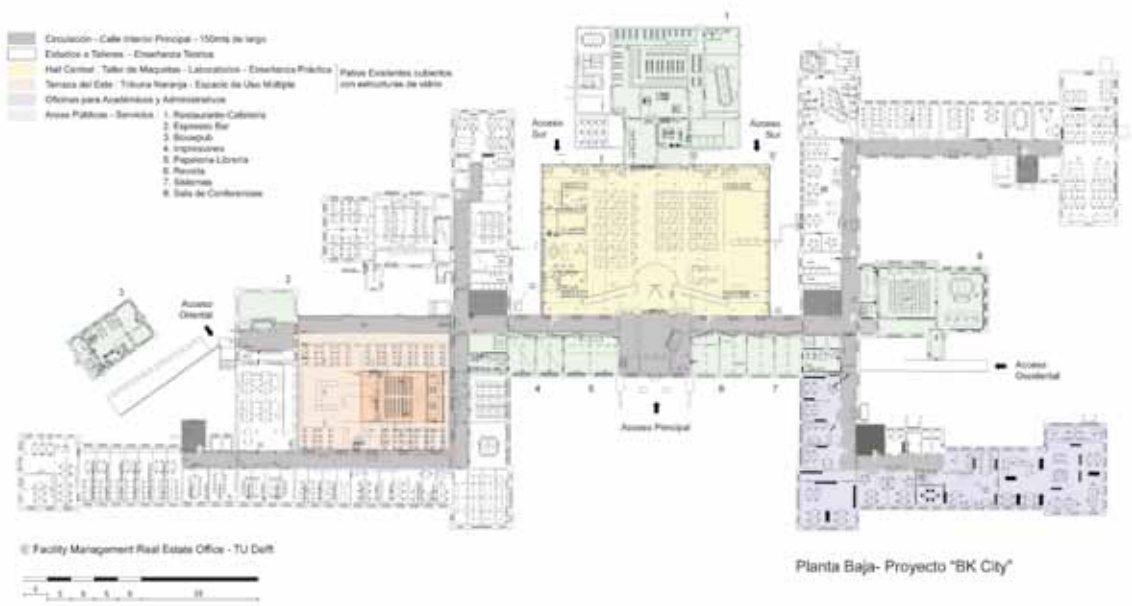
Planta baja proyecto BK City. Versatilidad programática del edificio.
